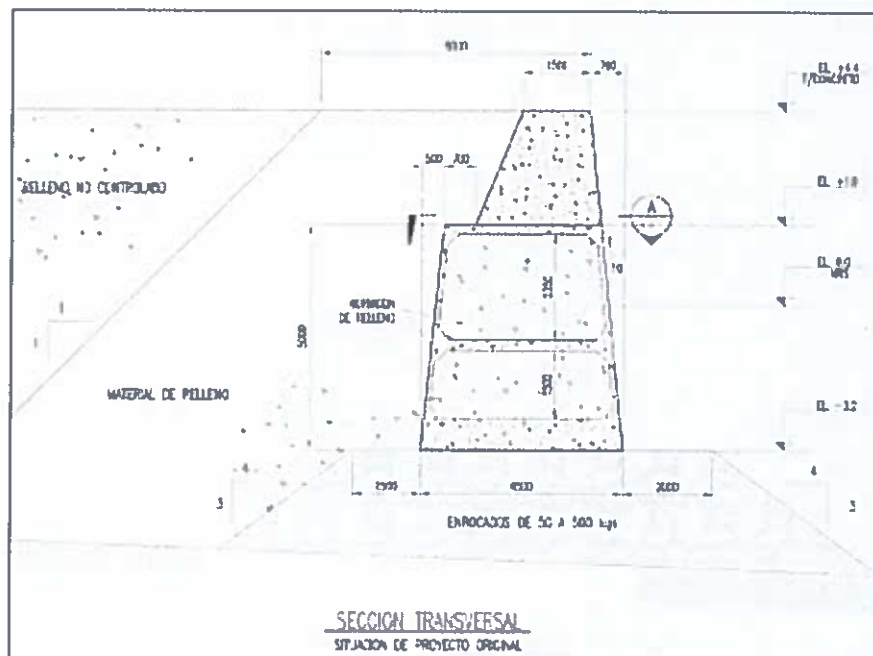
Sección transversal de muros Sitio N° 1 del Puerto de Anca
